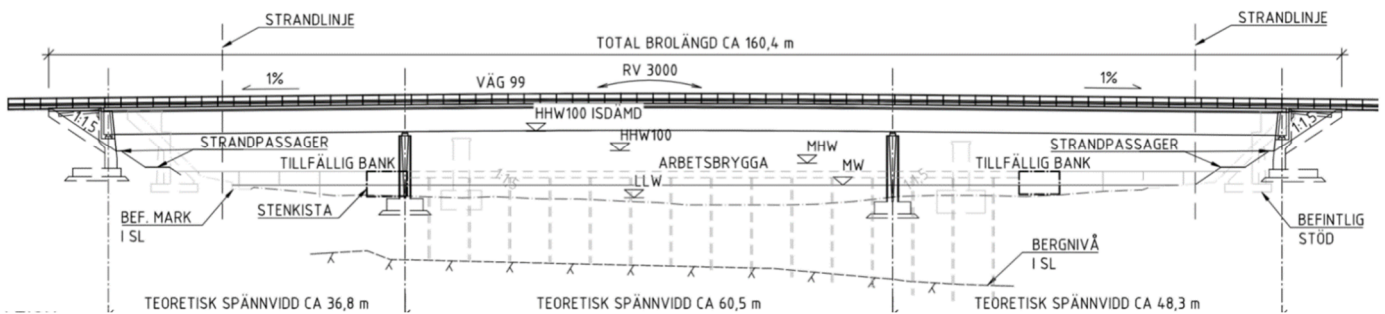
, Elevation tillfällig bro (norr till vänster).
